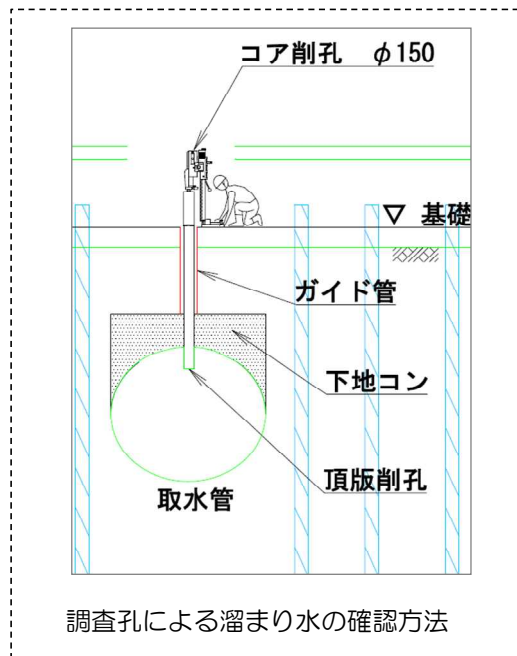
【11-12】3号機取水管-北①② 施工方法（貫通施工）
